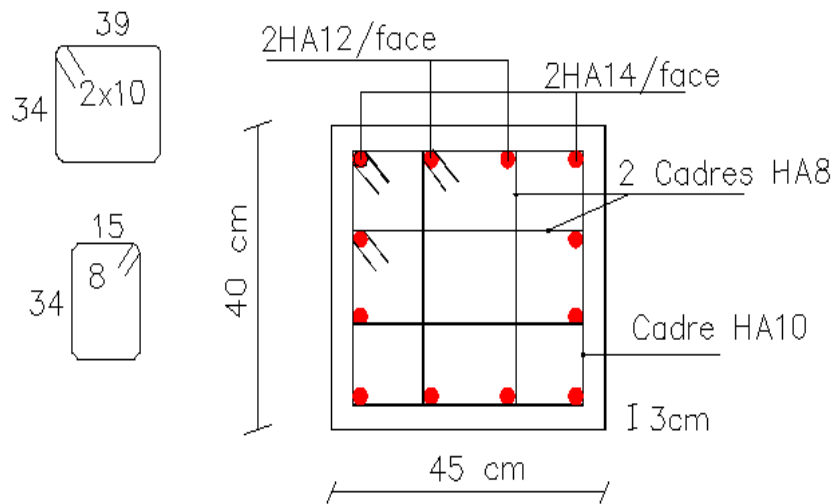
Schéma de ferrailage des poteaux d'étages 7 et 8
